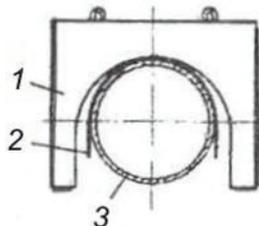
Схема установки железобетонного пригруза на трубопровод диаметром 1420 мм:
